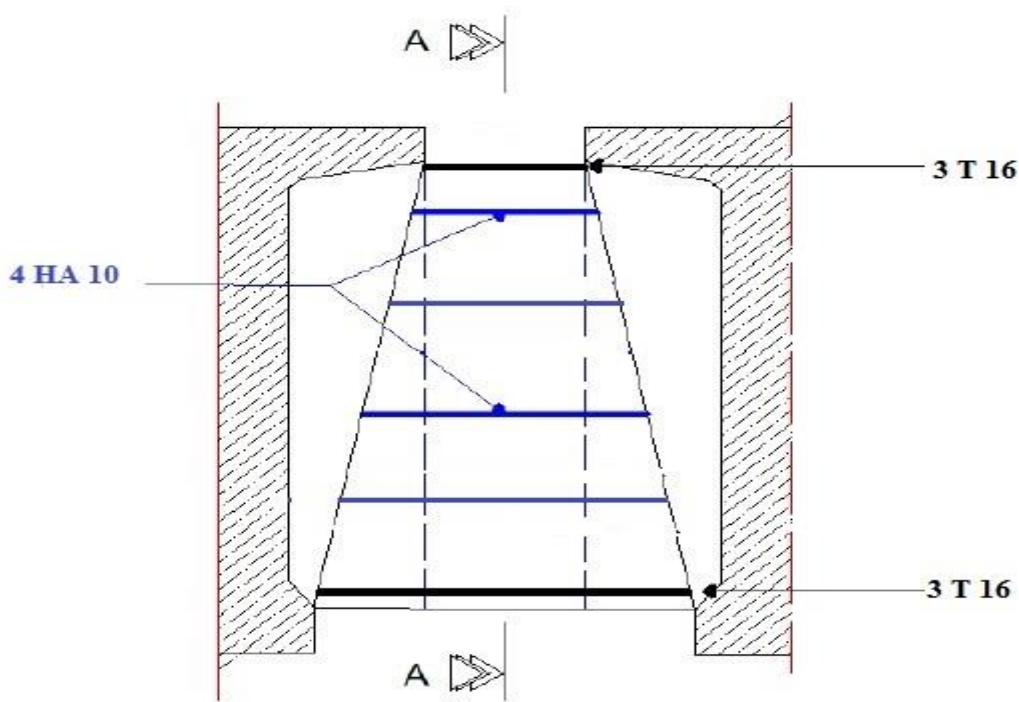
Coupe de ferrailage de l'entretoise d'about
